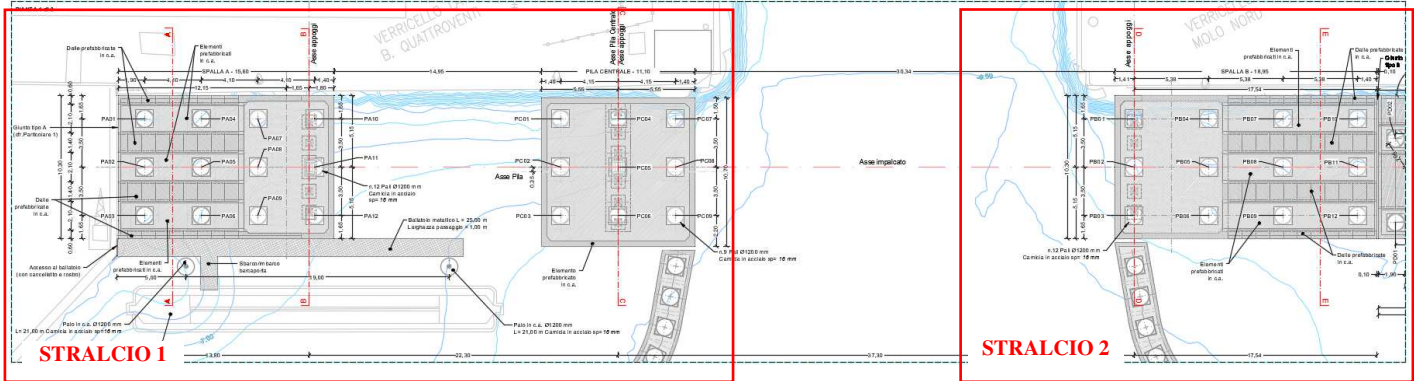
Planimetria della viabilità su pali (Spalla A, Pila Centrale e Spalla B)
